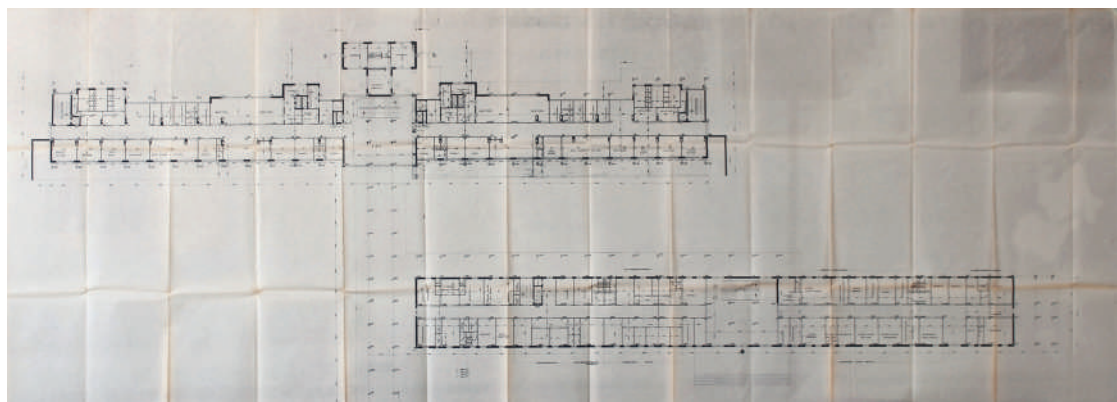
Raffaele Argo, Progetto di completamento e ristrutturazione dell'Ospedale, 2° lotto. Monoblocchi A e B, piano rialzato. Pianta, scala 1:100, 20 marzo 1972 [da AOAPPCNa].
